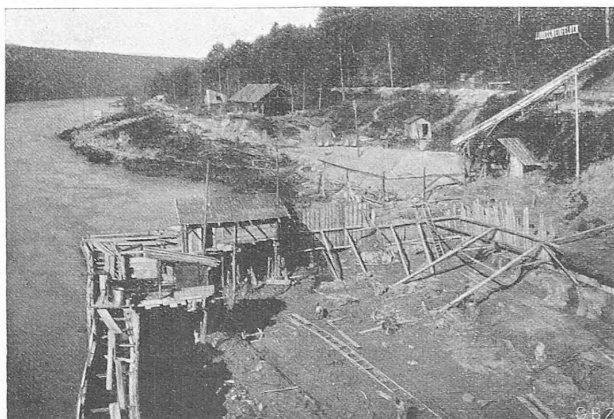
Baugrube für die Schleuse am rechten Rheinufer.
